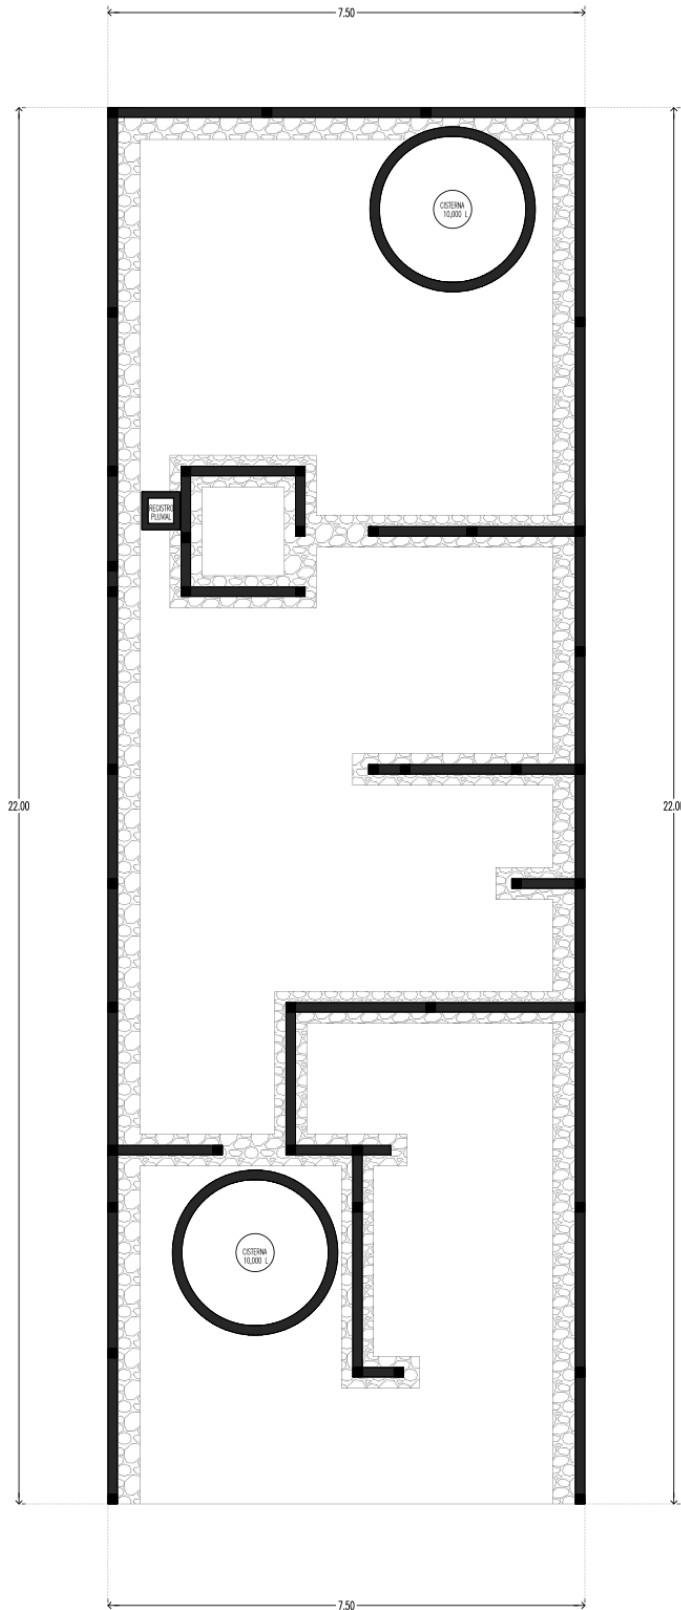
Planta de cimentación de la vivienda, etapa 1.
